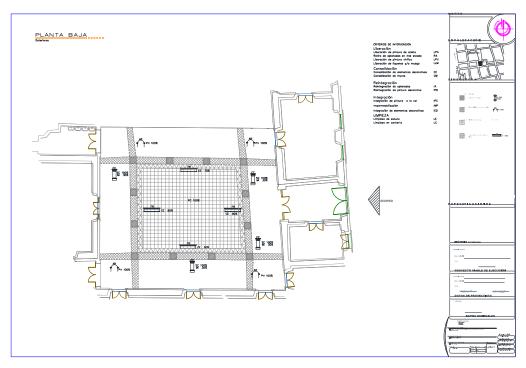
Plano de deterioros en Planta. Eloísa Galván González. 2016.
